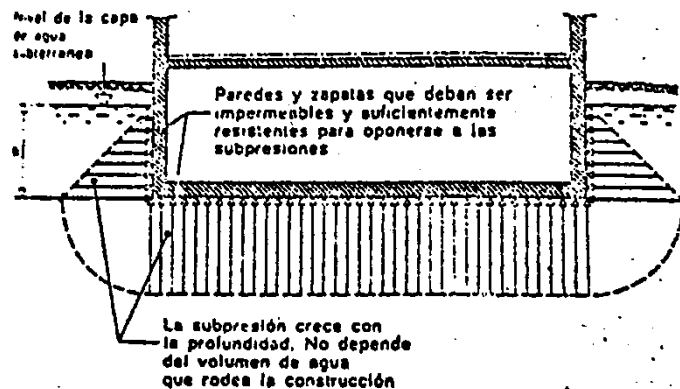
Subpresiones actuantes en paredes y piso de estructura enterrada.
